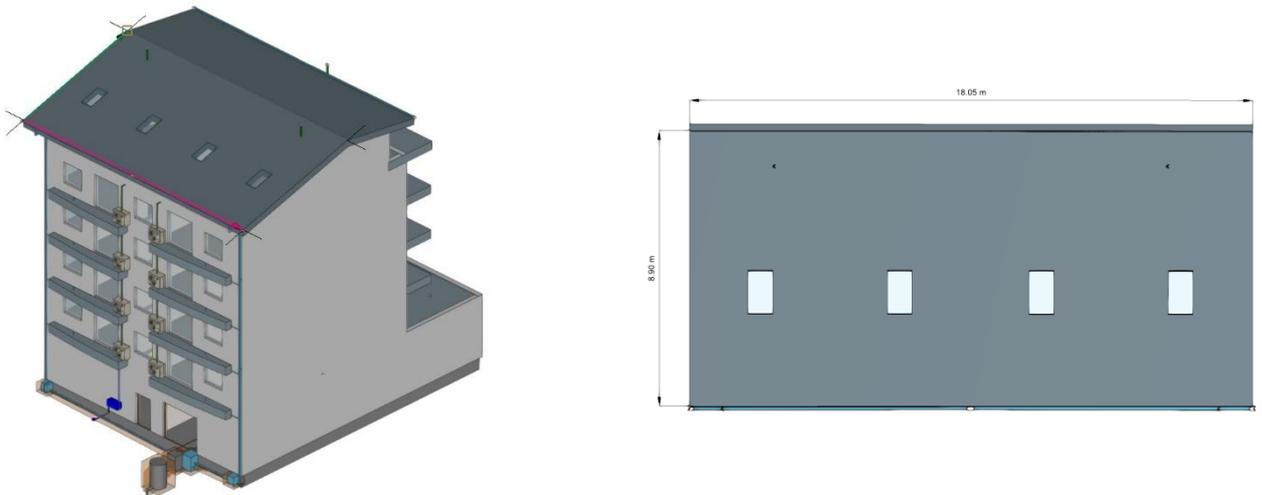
Vista de plano genérico (Open BIM Lightning)
